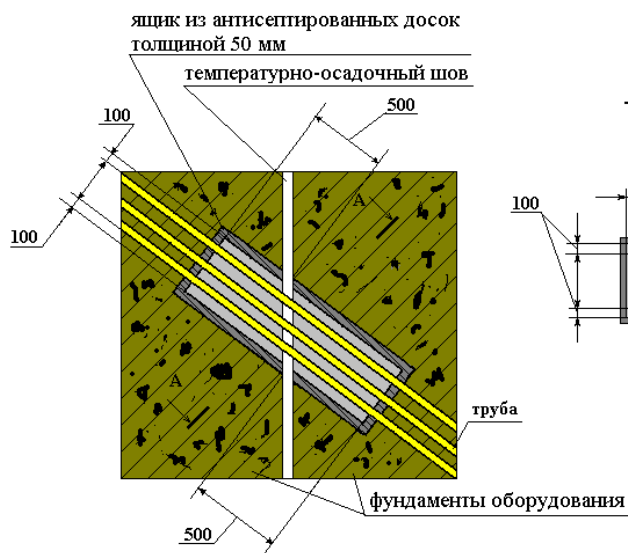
Защита стальных труб при переходах через температурно-осадочные швы фундаментов.
